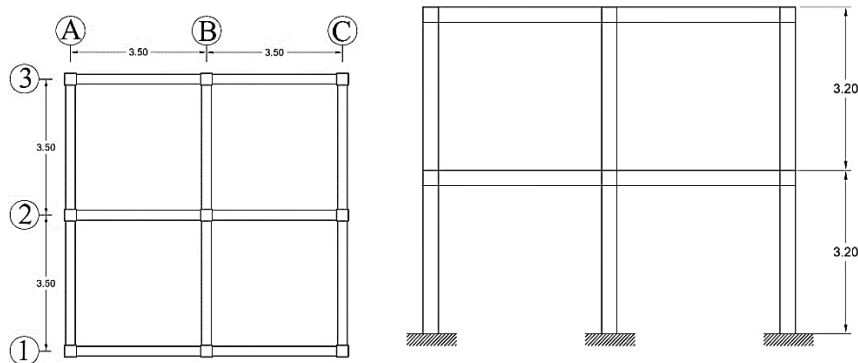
Estructura aporricada de baja altura (vista en planta y elevación)
